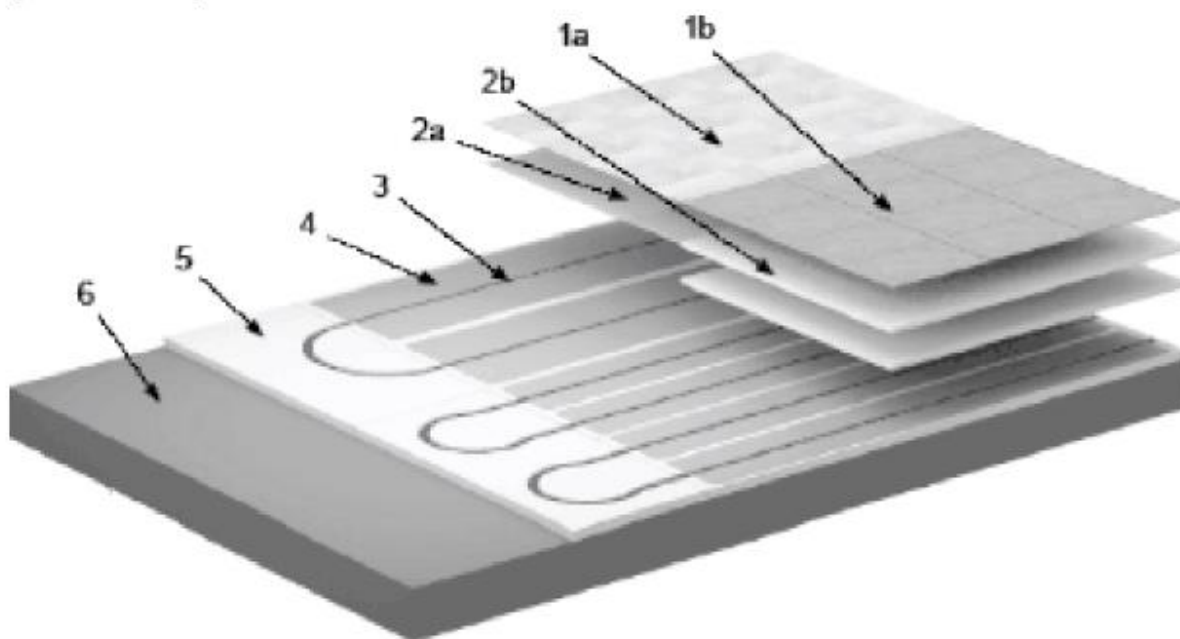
Спосіб укладки труб безбетонної системи водяної теплої підлоги:
